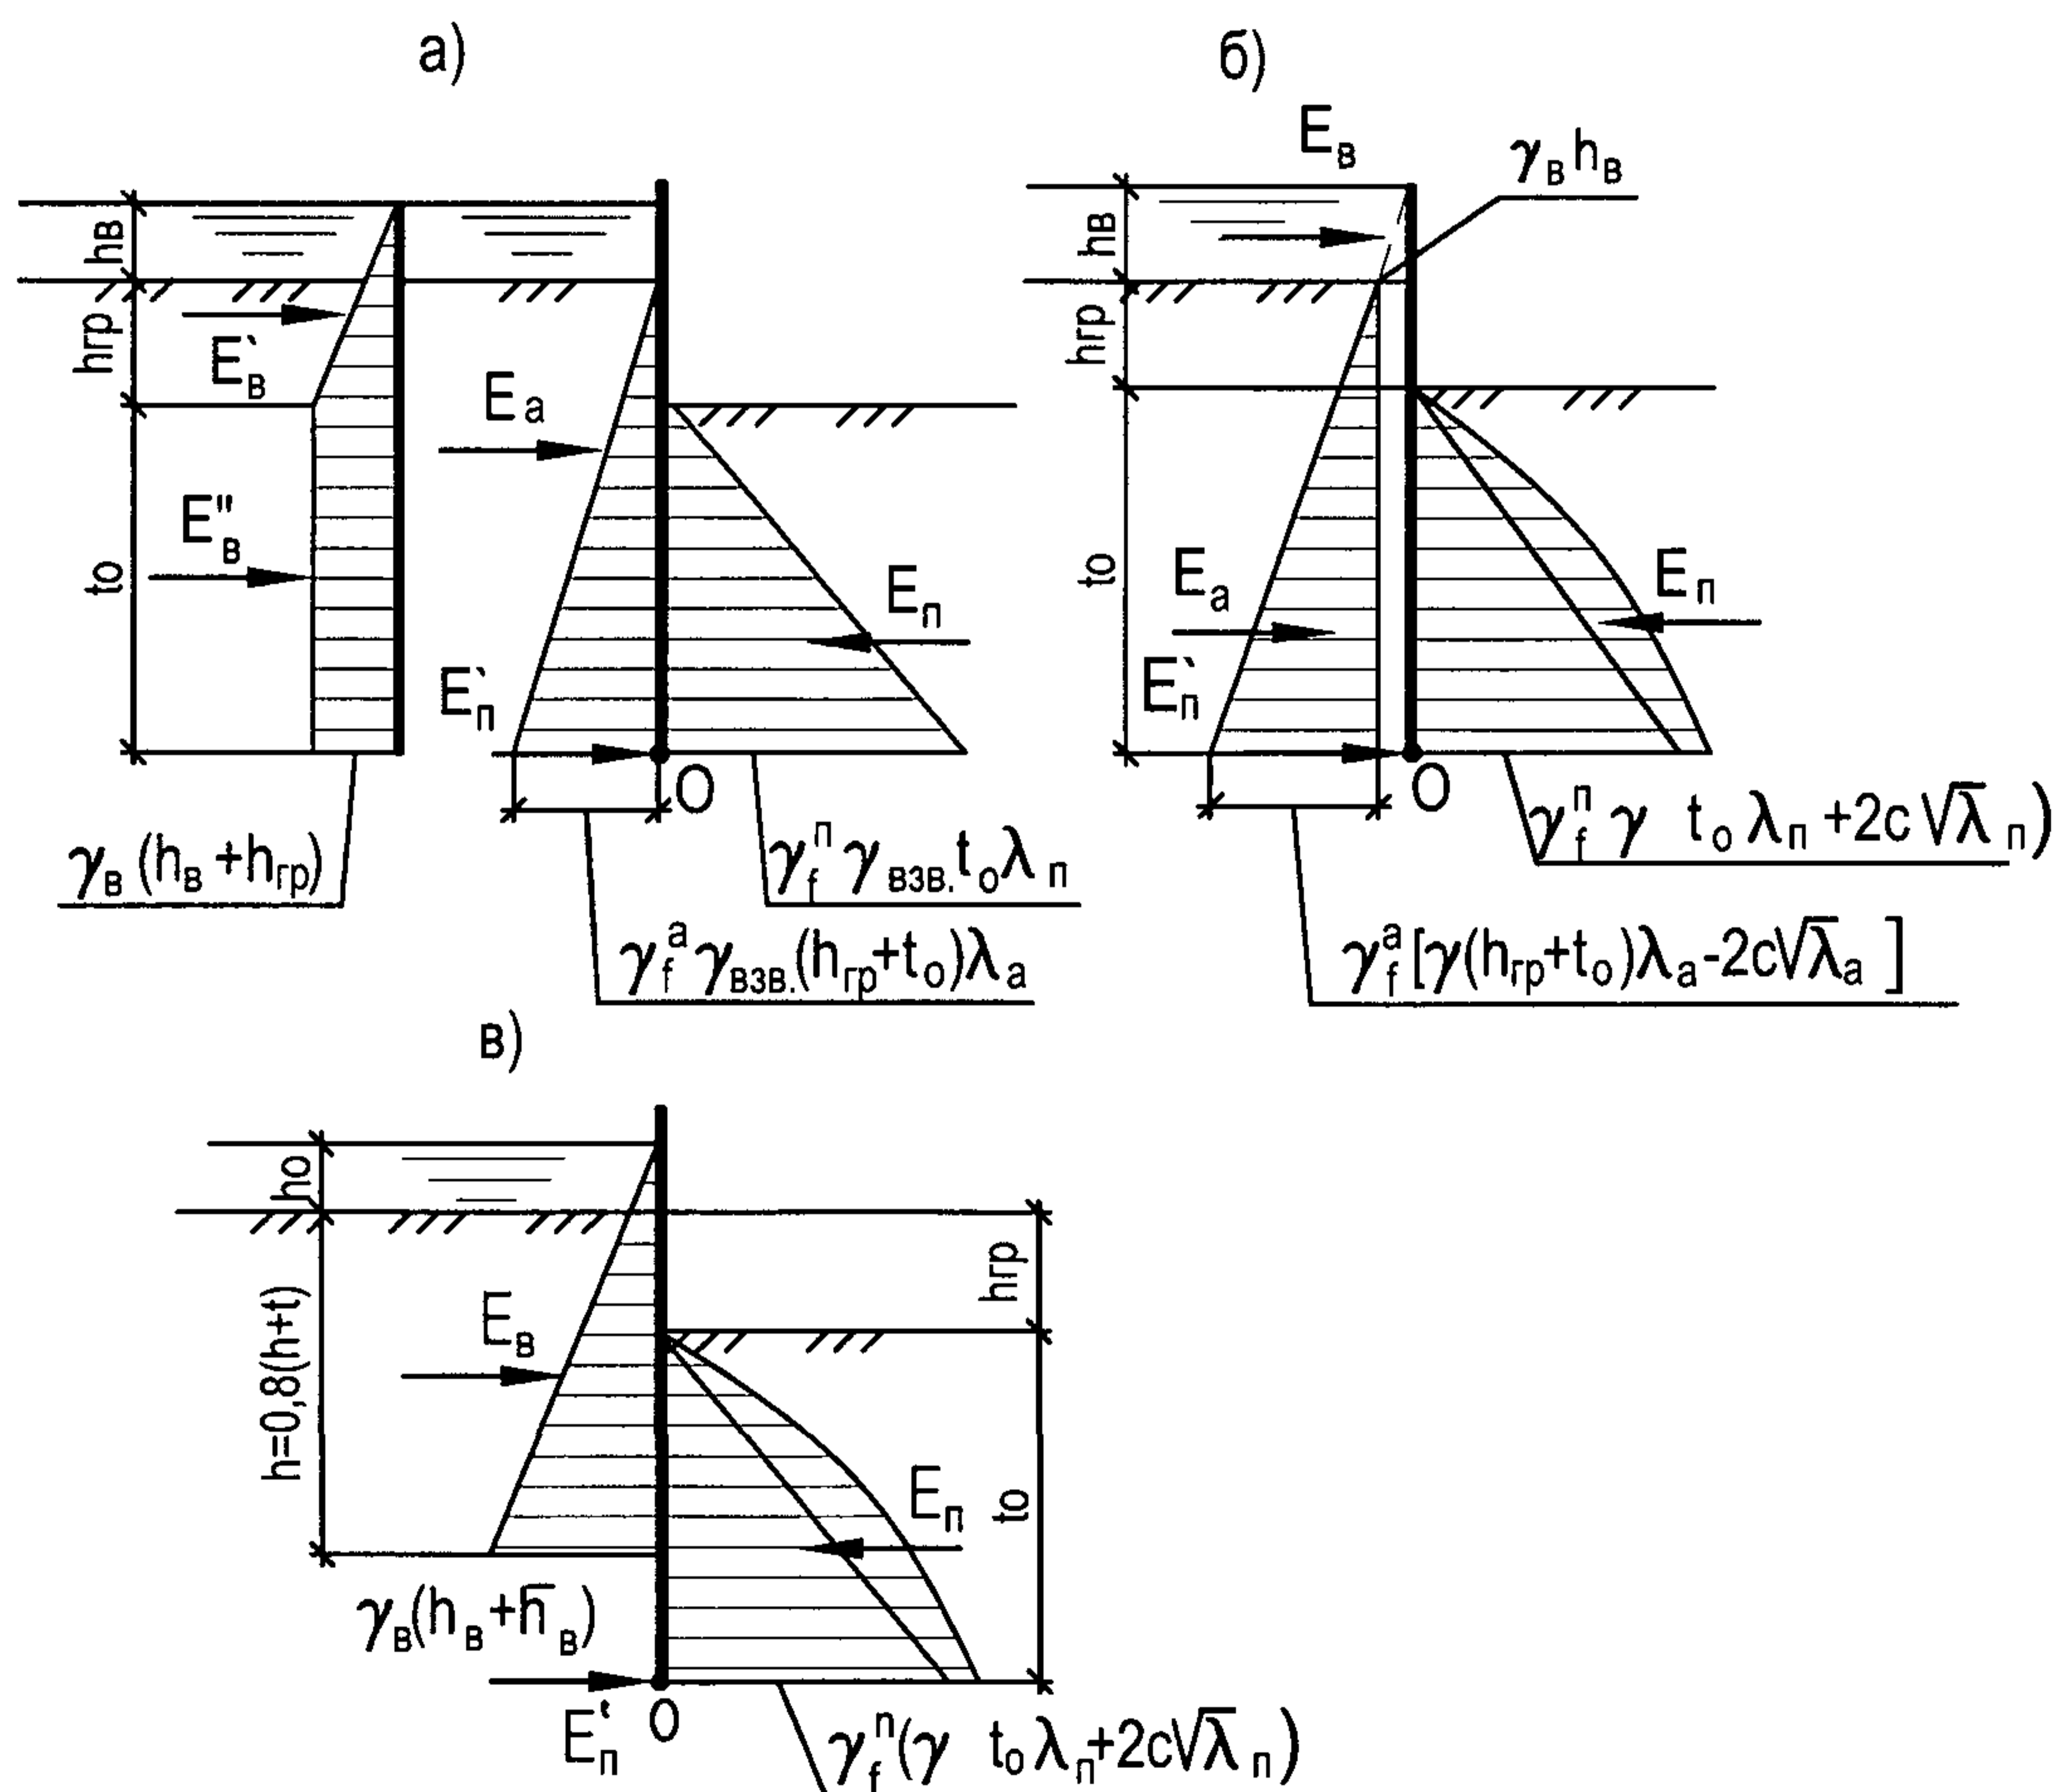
Схемы, используемые в расчетах шпунтовых ограждений, не имеющих распорных креплений.
